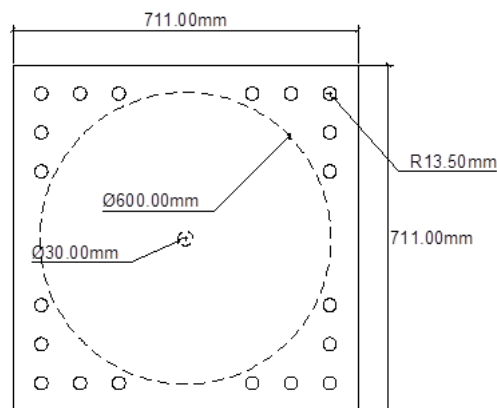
Dispositivo aislador HL060X4R - vista en planta
